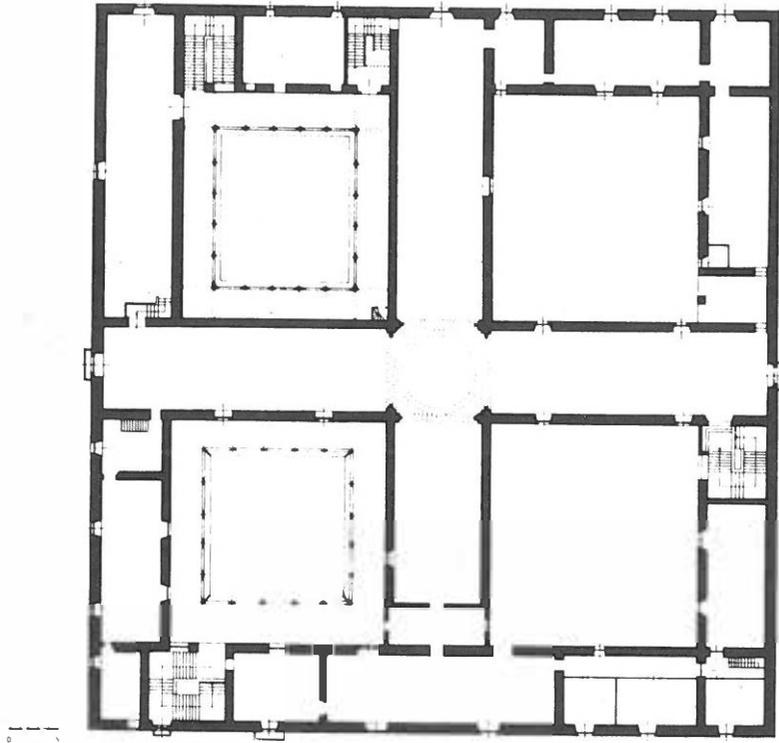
Hospital Real. Planta principal. Ver analogía y diferencia con la planta baja del plano anterior.
